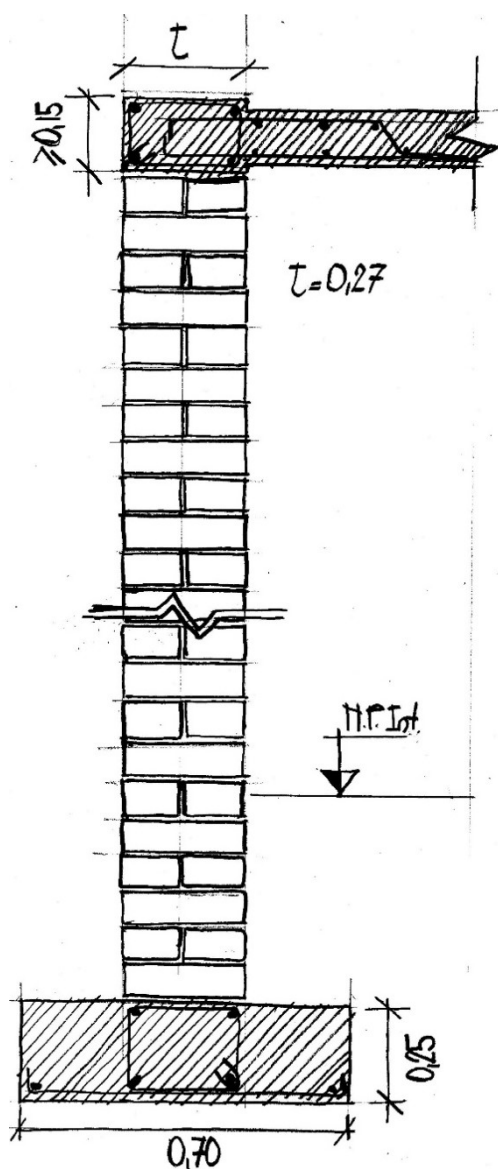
Encuentro Encadenado horizontal superior y losa maciza
